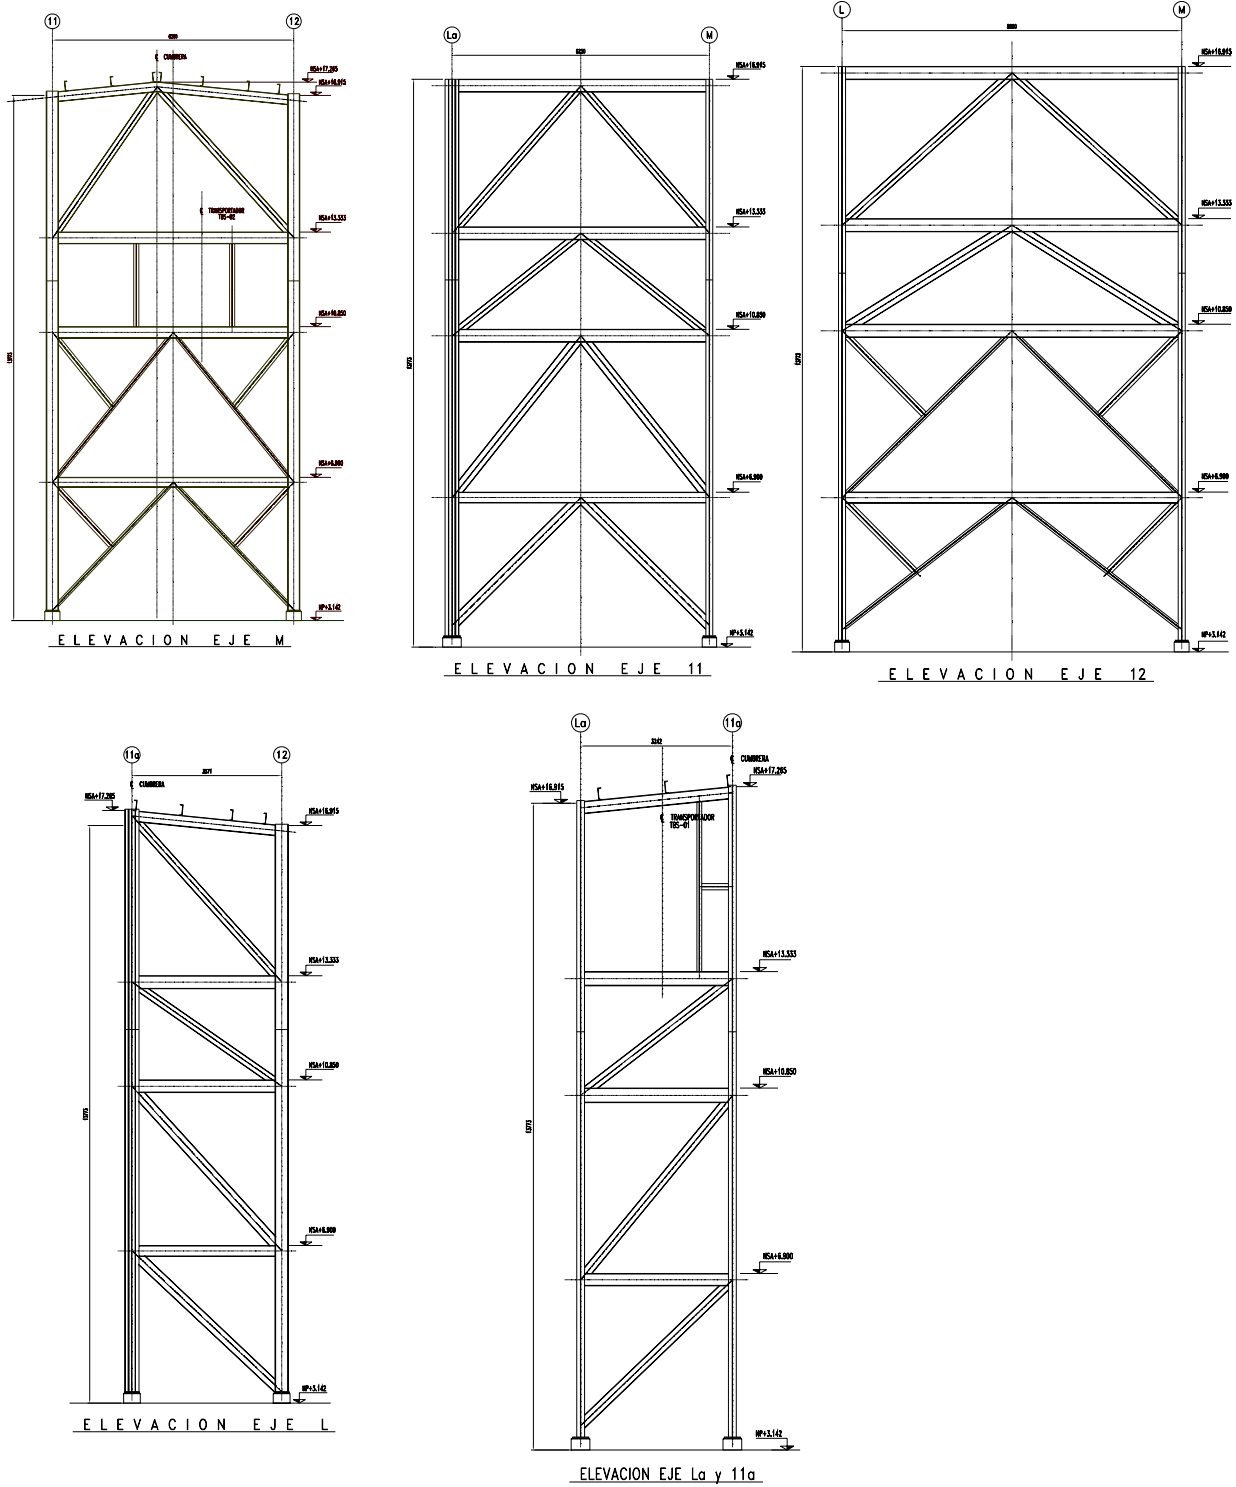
Elevaciones de Marcos Estructurales en Torre TT-2.
